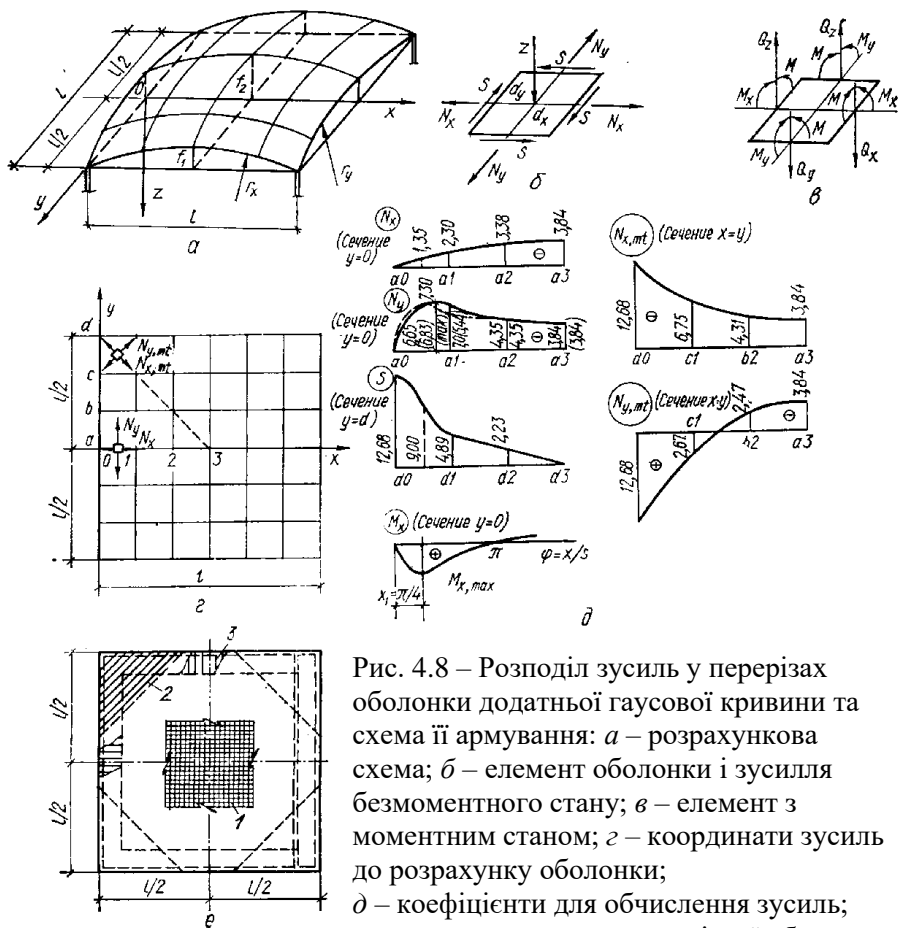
Розподіл зусиль у перерізах оболонки додатньої гаусової кривини та схема її армування: *a* – розрахункова схема; *b* – елемент оболонки і зусилля безмоментного стану; *в* – елемент з моментним станом; *г* – координати зусиль до розрахунку оболонки; *д* – коефіцієнти для обчислення зусиль; *e* – схема армування монолітної оболонки; 1 – арматура, що сприймає зусилля  $N_x$ ; 2 – арматура, що сприймає зусилля  $N_{y,mt} > f_{ctk}$ ; 3 – арматура, що сприймає моменти  $M_x$
